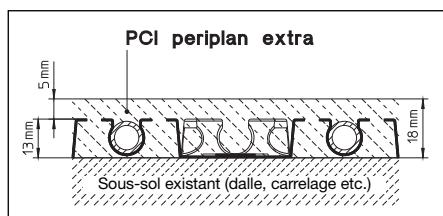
PCI periplan extra (recouvrement minimal 5 mm, hauteur total de mise en œuvre 18 mm)
